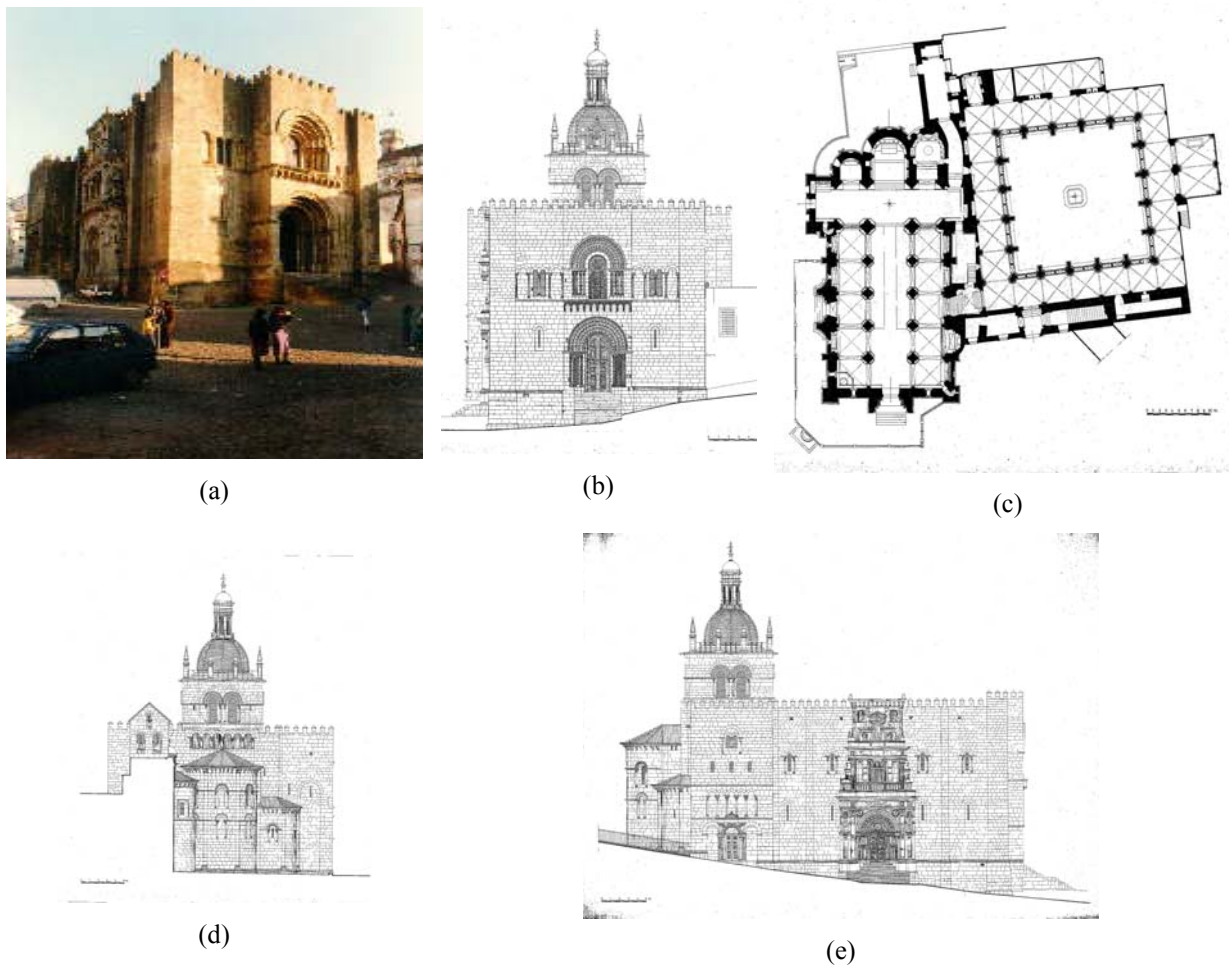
Peças desenhadas [Fonte: DGEMN]: (a) fotografia; (b) alçado frontal; (c) planta; (d) alçado posterior; (e) alçado lateral.
